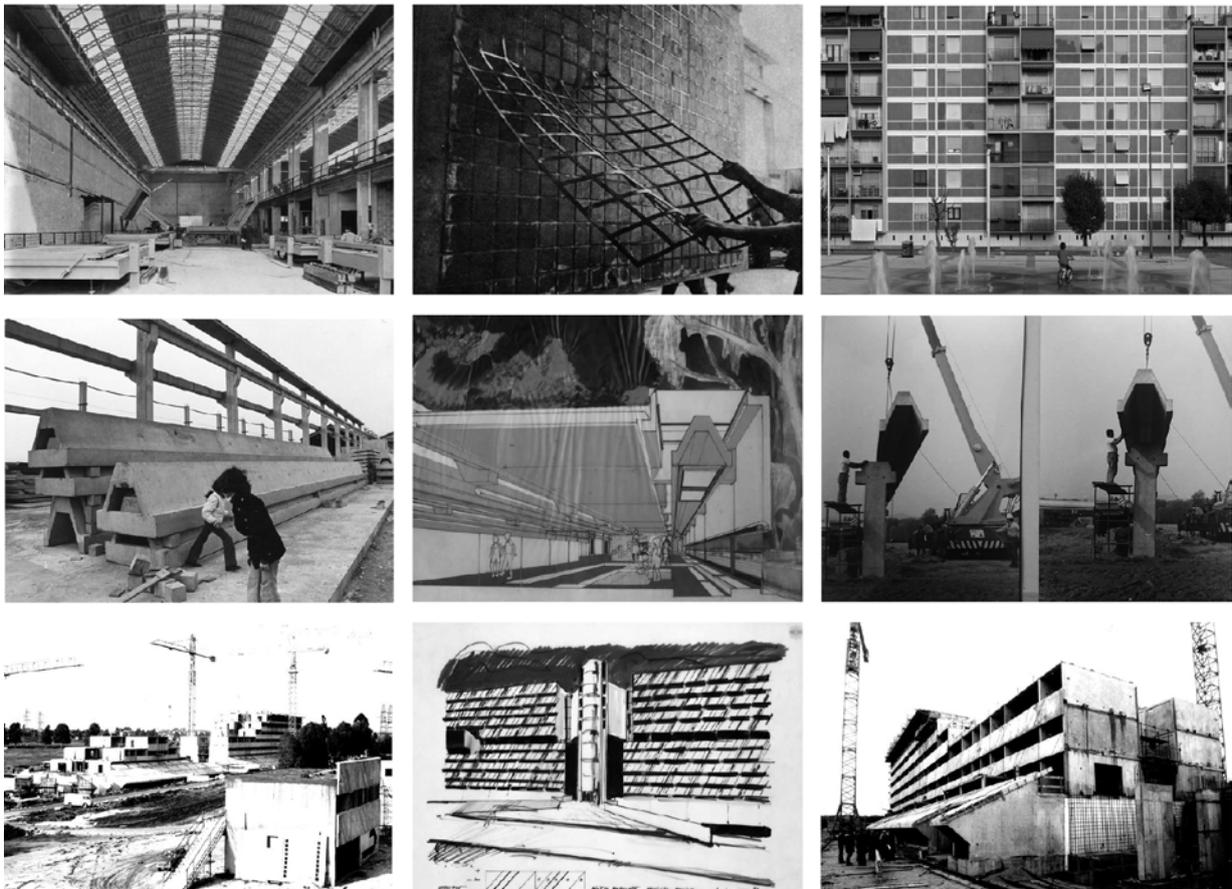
Da sin a des, dall’alto in basso: MBM, stabilimento di Trezzano, 1964; MBM-Magistretti, fabbricazione dei pannelli di facciata, 1964; MBM-Magistretti, quartiere degli Olmi, 2011 (foto S. Poretti); L. Pellegrin, componenti prefabbricate del sistema BENINI, stoccaggio, scuola materna (sezione e cantiere), 1968; M Fiorentino e altri (strutture R Morandi) Corviale, “mock-up” del pannello di facciata, 1977; N. Carrino, Corviale, disegno del fregio di facciata, 1970; M. Fiorentino e altri (strutture R. Morandi) Corviale, cantiere, 1977.
